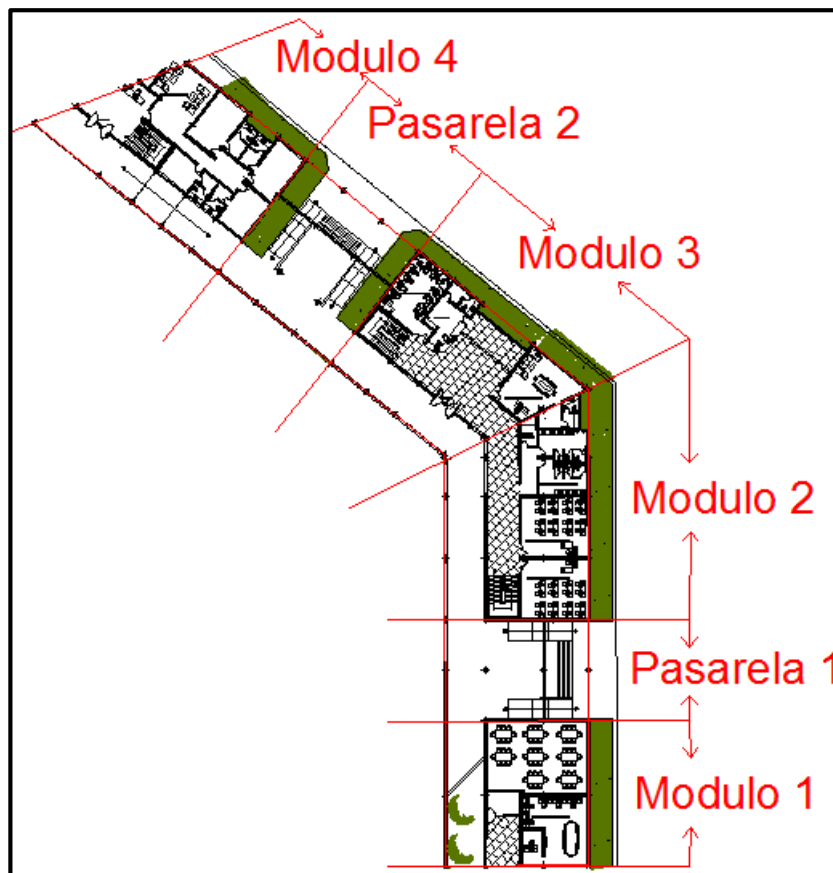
Vista de Planta de la Distribución de Secciones por Módulos.
